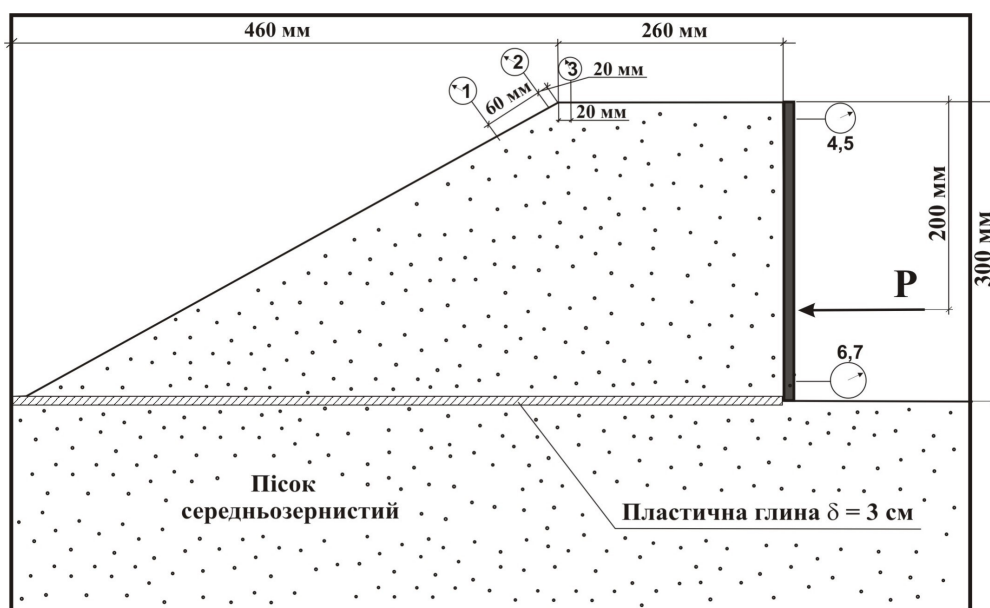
Схема моделі без ґрунтоармуючої конструкції з прошарком з глини
